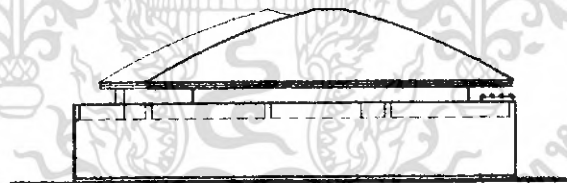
แสดงแปลนอาคาร Studio Building 2
